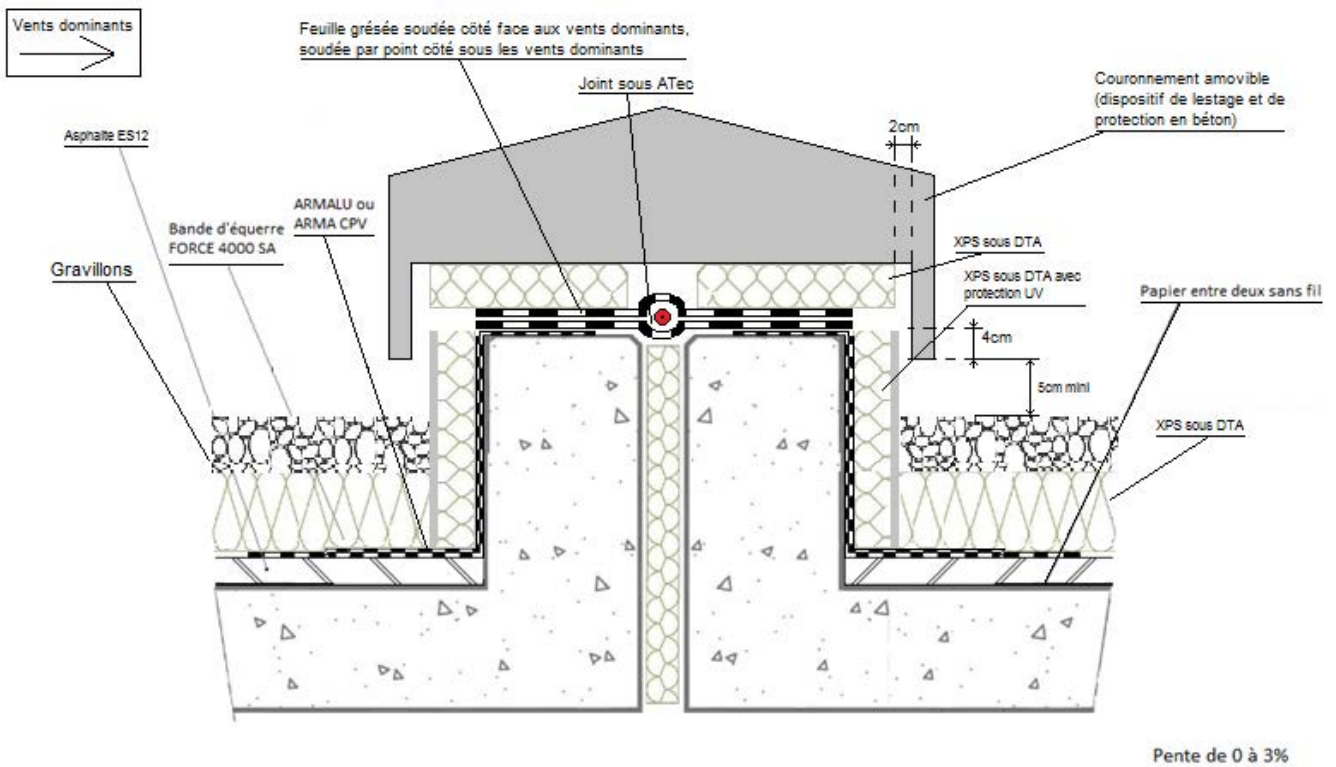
Joints de dilatation - Terrasse inaccessible, protection par gravillons
